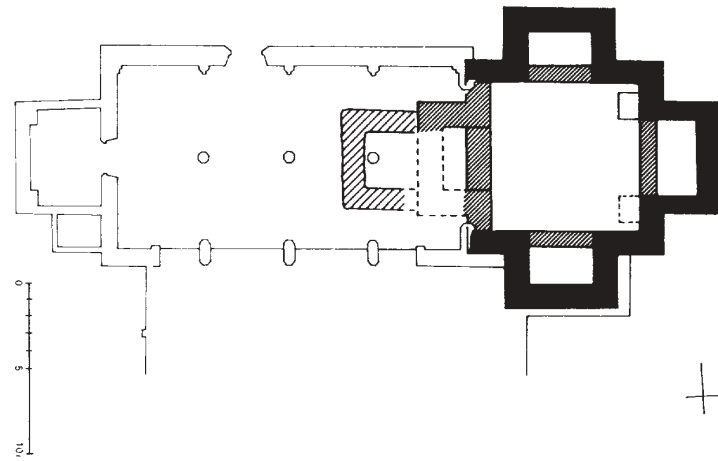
Wieselburg, St. Ulrich, erbaut nach 973 (Rekonstruktion H. LADENBAUER-OERL).
